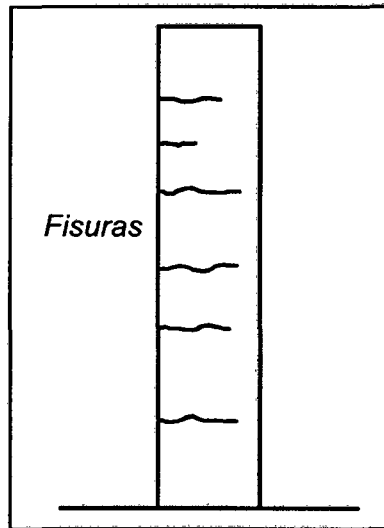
Fisuración transversal en pilares debida al pandeo (Pérez, 2008).
